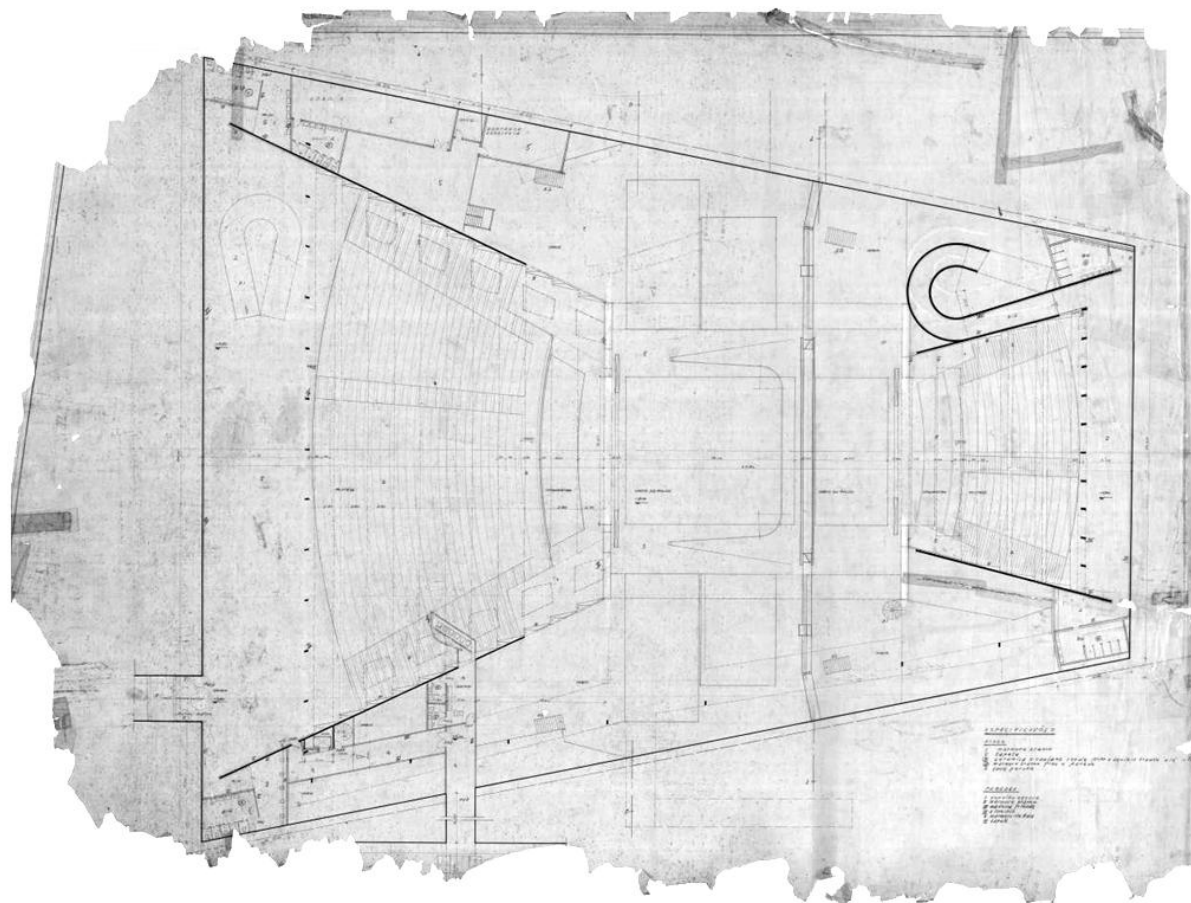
Planta Baixa - Subsolo 1 (sem data). Planta sem carimbo, provavelmente de 1960.
